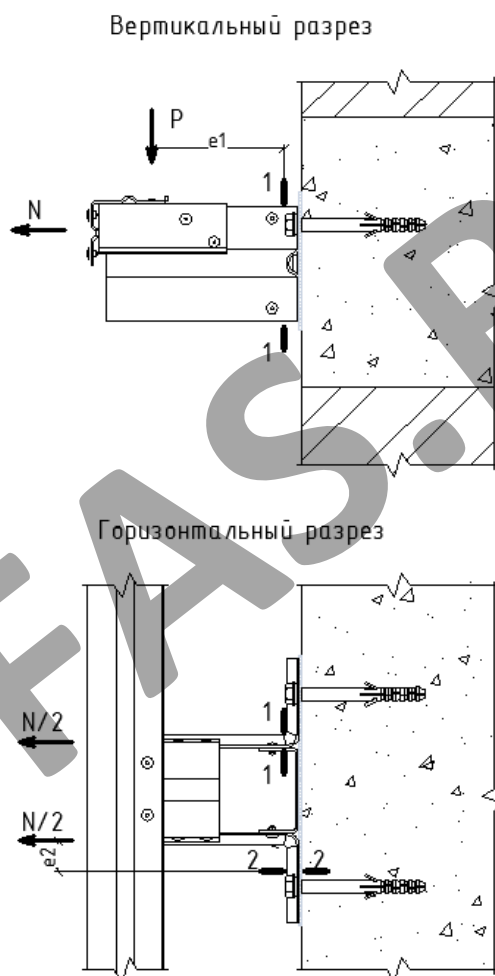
Расчётная схема кронштейна КНс-27
